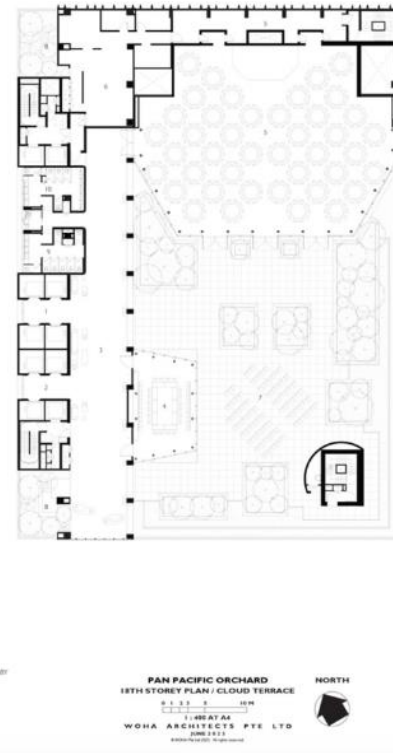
План Хмарна тераса 18-го поверху (готель Pan Pacific Orchard) [1]
